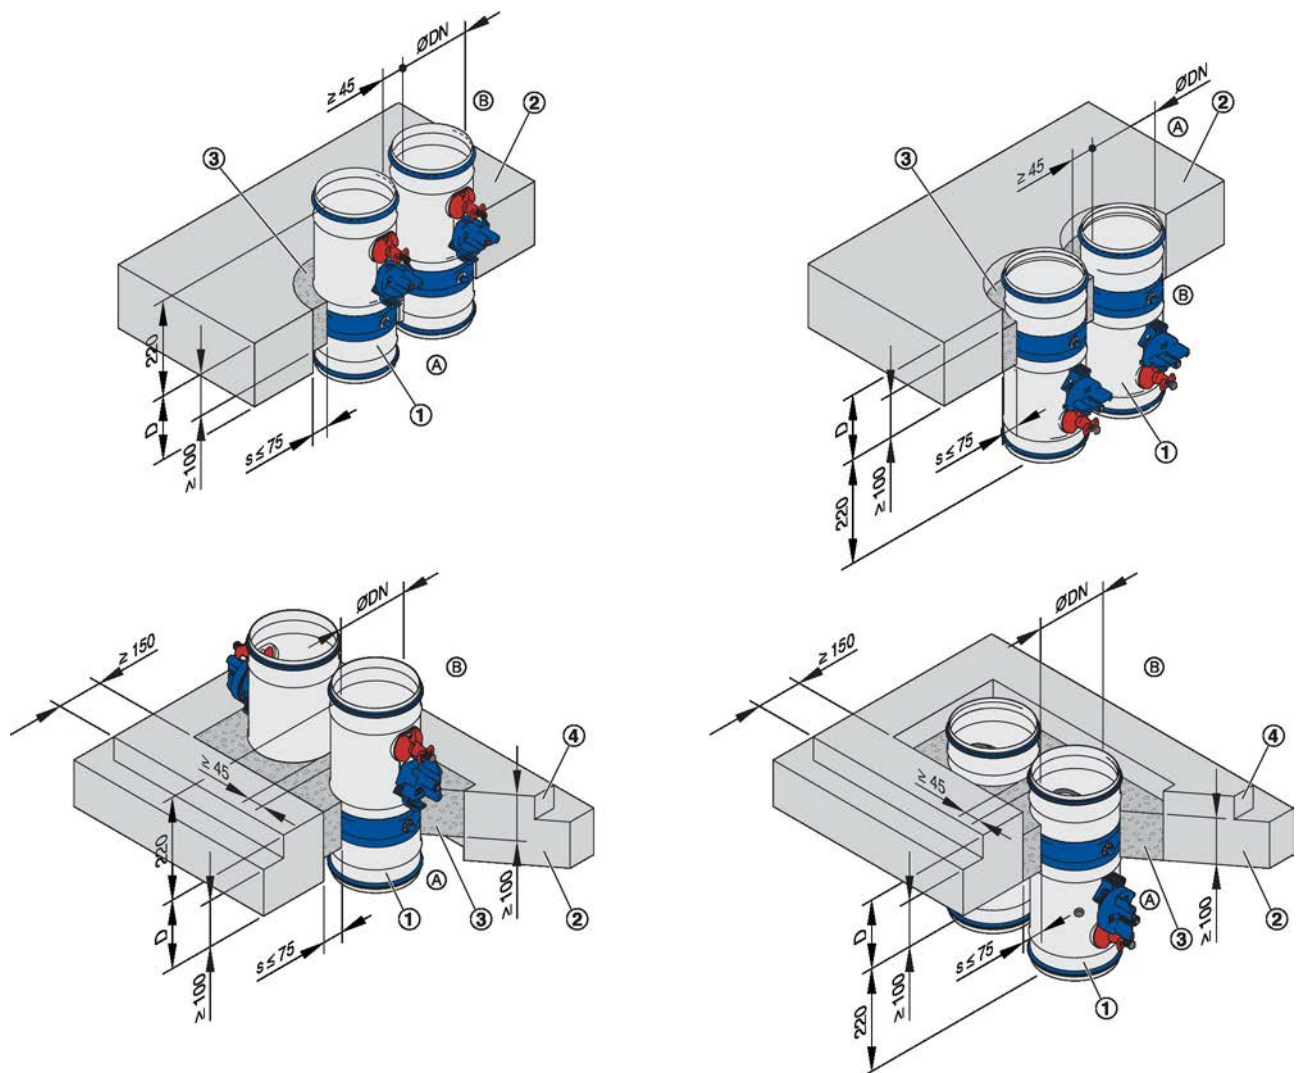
Montage à base de mortier en plafond plein, suspendu ou à la verticale, deux clapets coupe-feu côte à côte
